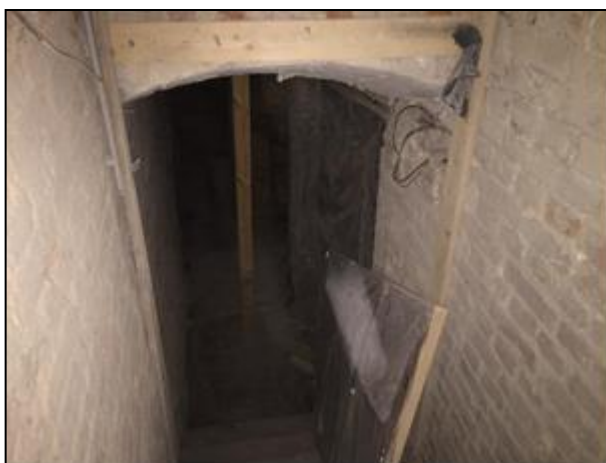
Проход и лестница со стороны здания по адресу: СПб, наб. р. Мойки, д. 82, лит. В
